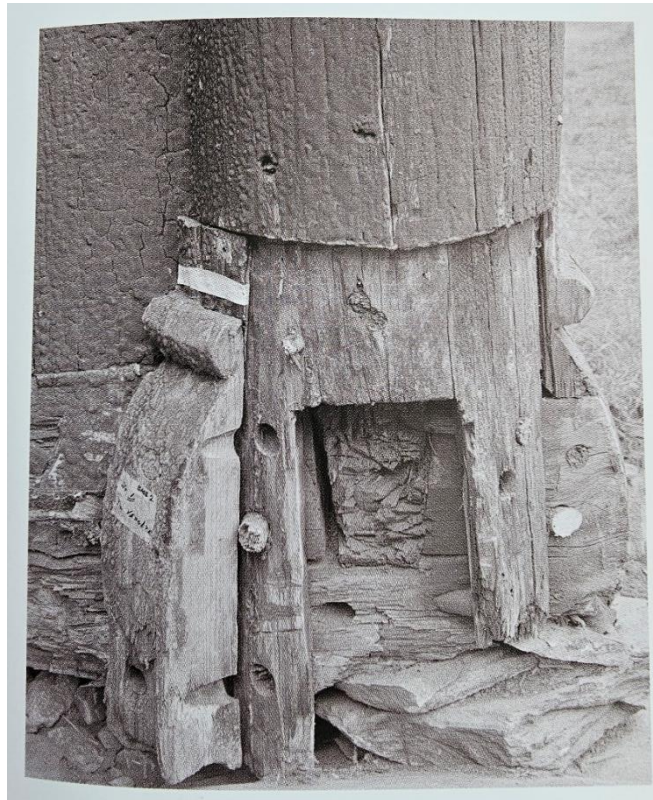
Ferdig laftet sammen. Det er lagt inn litt sigemon siden emnene fortsatt var ganske ferske under sammenføyningen. Under ferdig montering var svillene på lik høyde. Foto Åsmund Stormoen.
